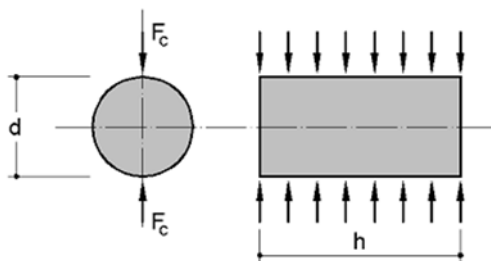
Ensaio de tração por compressão diametral (PINHEIRO (2004))
